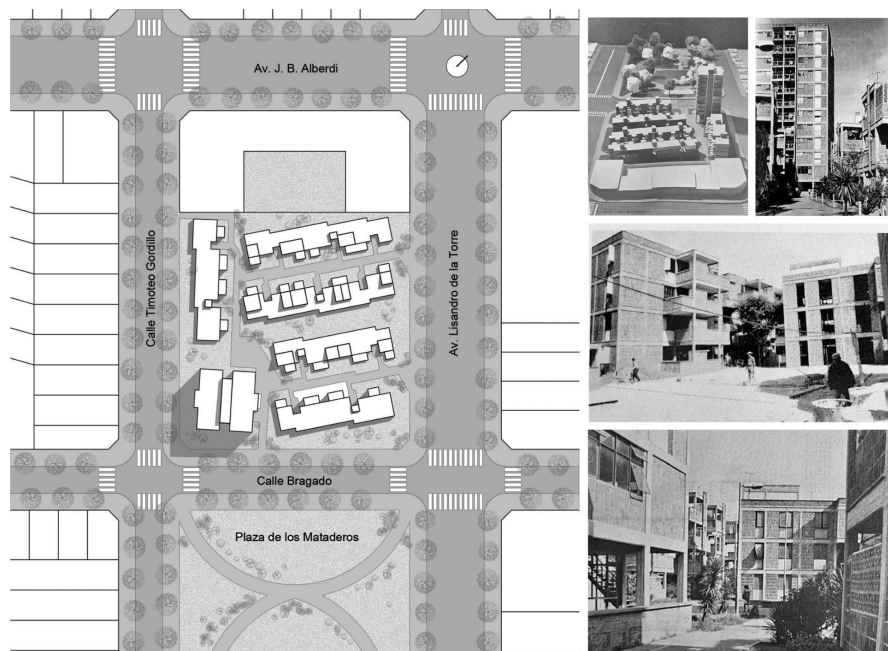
Barrio Justo Suárez | planos de conjunto | fotografías a 10 años de su construcción
